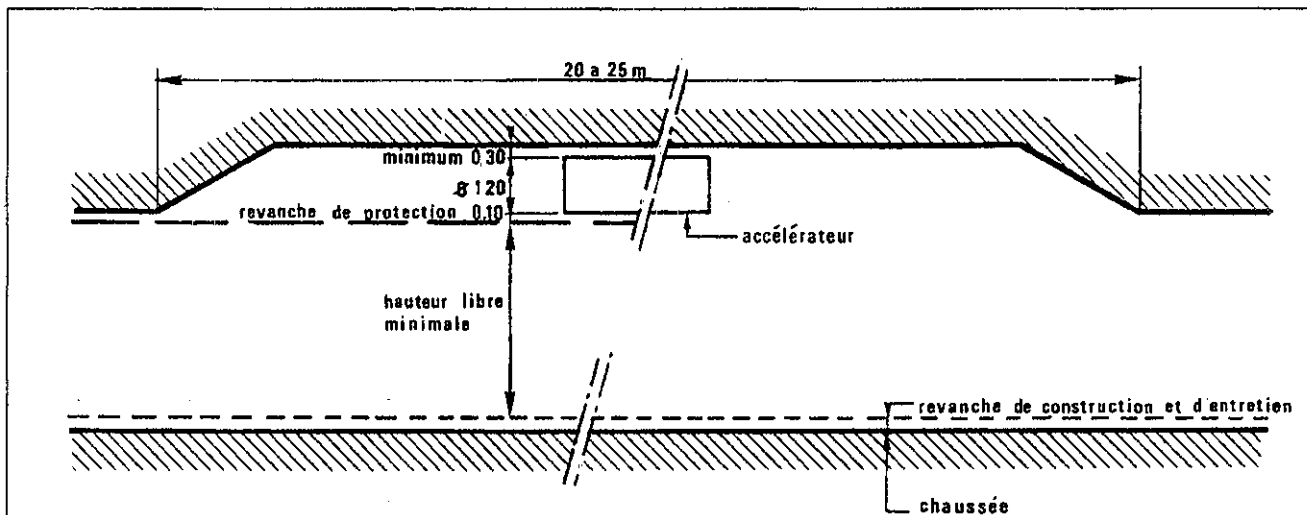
Coupe au droit d'une niche de ventilation
